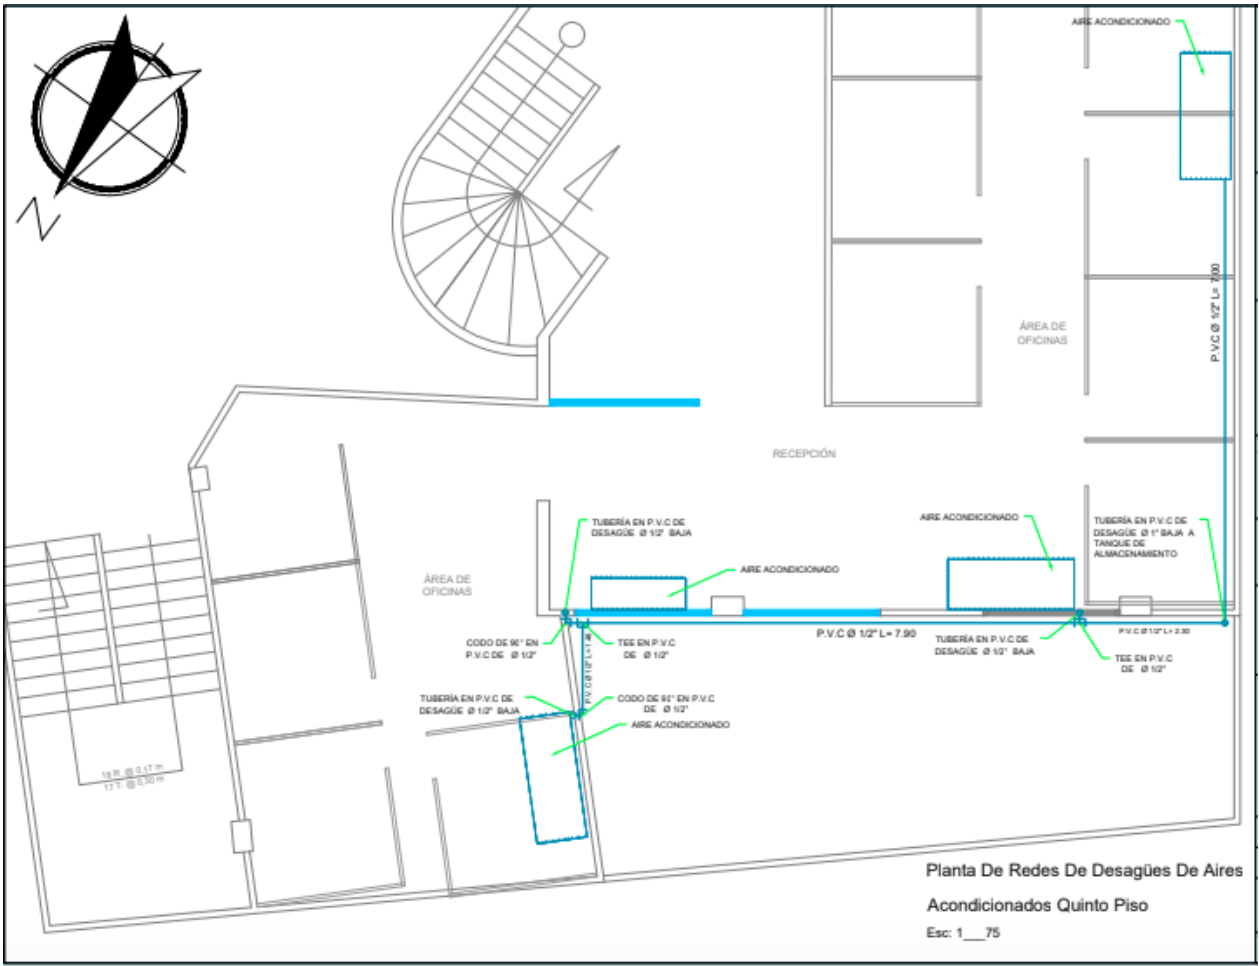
Plano de redes de descarga quinto piso. Fuente: Autores 2019
